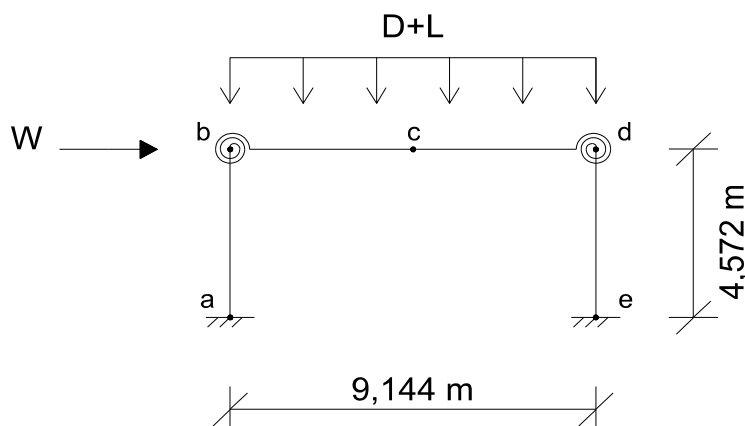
Pórtico plano de um andar com ligações semirrígidas
